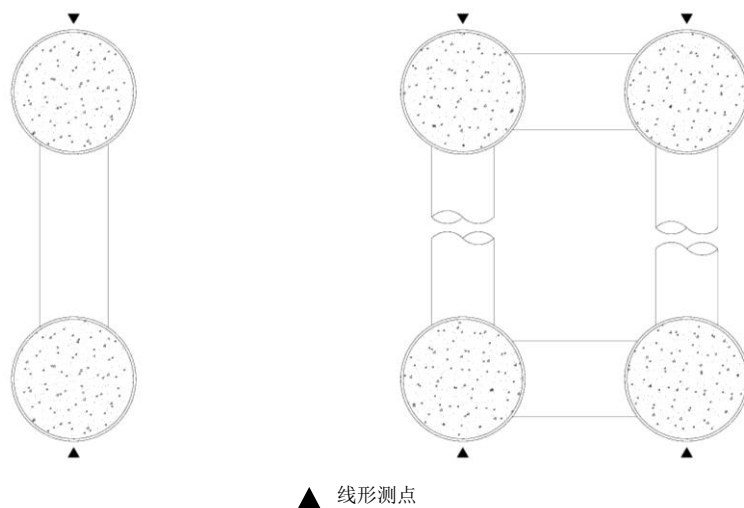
3 钢管混凝土拱圈断面线形测点布置示意图
